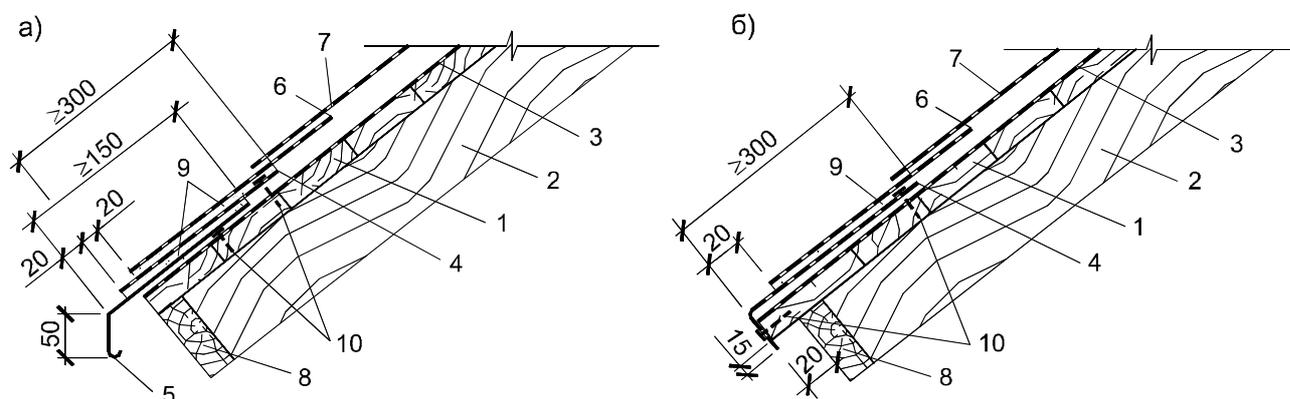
Схемы крепления плиток кровельных при разных уклонах кровли:
